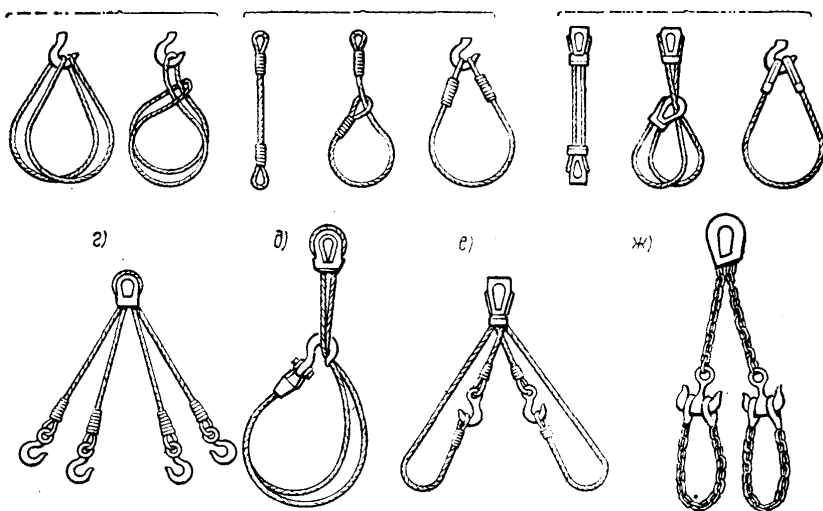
Типы стропов: а – универсальные; б – облегченный с коушами; в – облегченный двойной с коушами; г – четырехстропный захват с крючьями; д – со скользящим крюком; е – с коушами, крюками и петлями; ж – с двойными крюками и добовочными стропами
